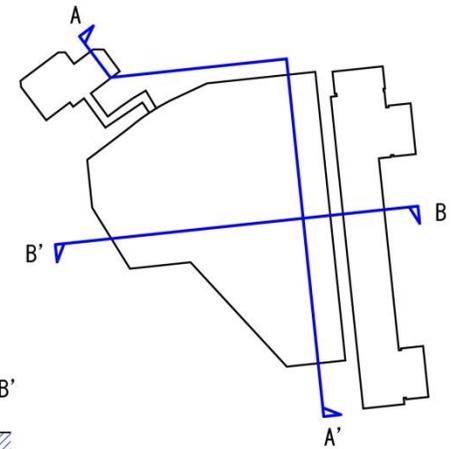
(2) 施設配置計画案3 (断面図) (配慮計画書から引用)
